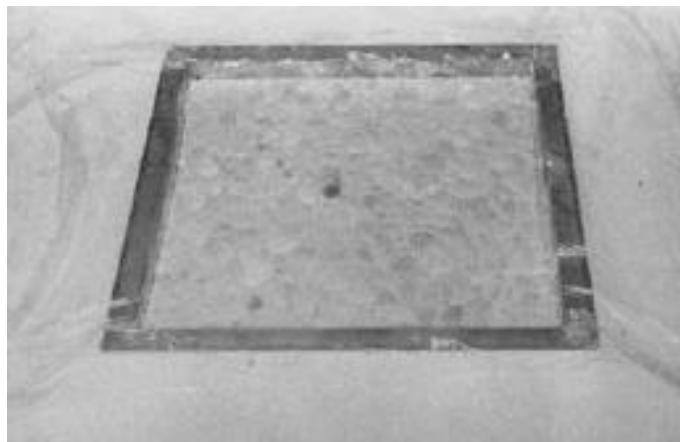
3. Lámina de plástico colocada sobre la plantilla
